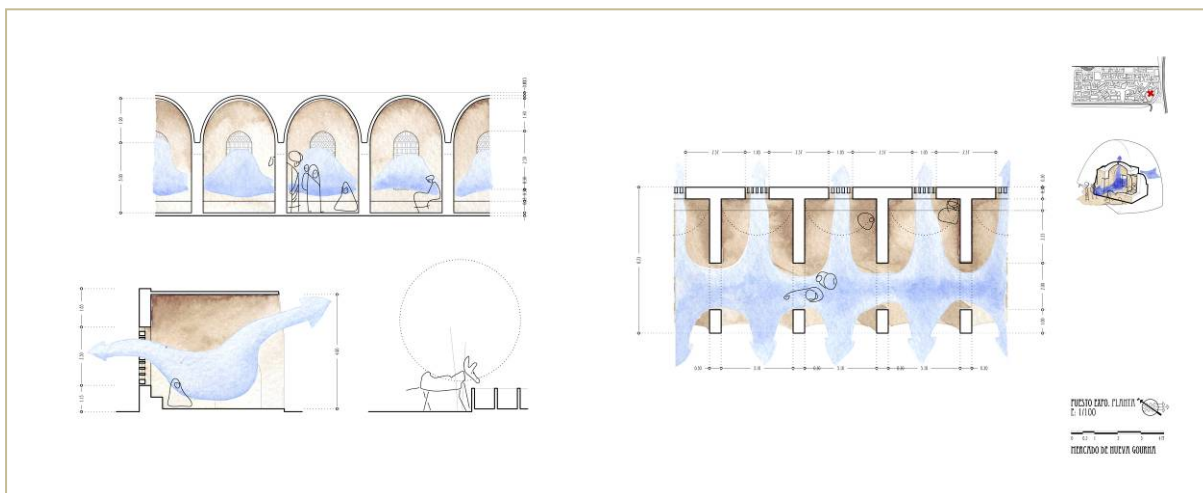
Secciones y planta del módulo tipo de puesto del mercado en Nueva Gourná. Redibujado por Javier Parra
